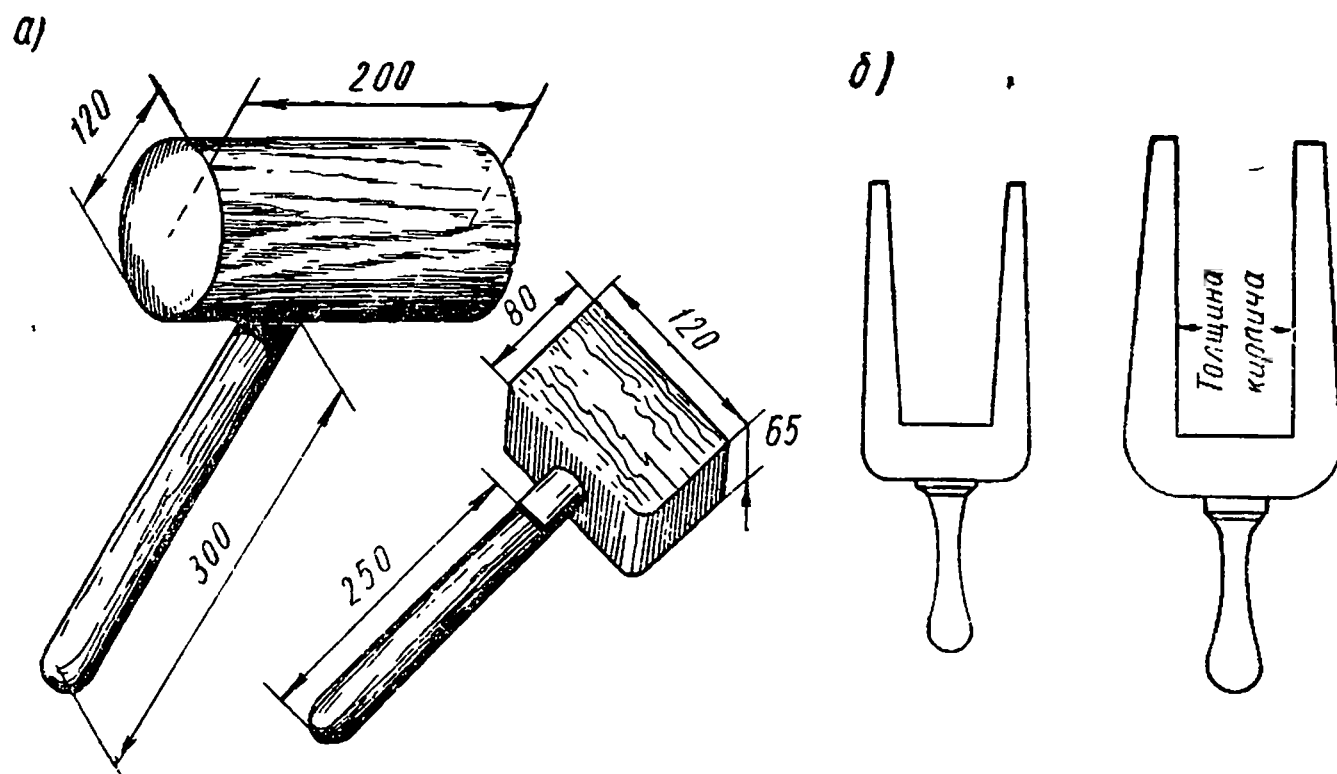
Дополнительный инструмент для обмуровочных работ:
